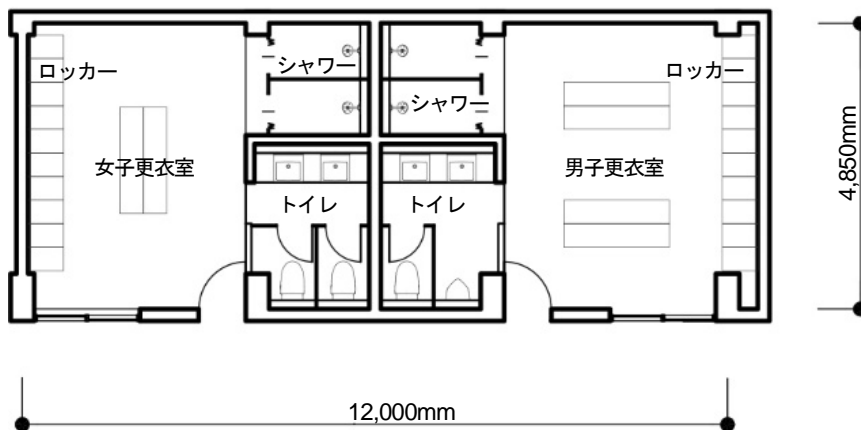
更衣室 1,2 (男、女更衣室) 平面図
